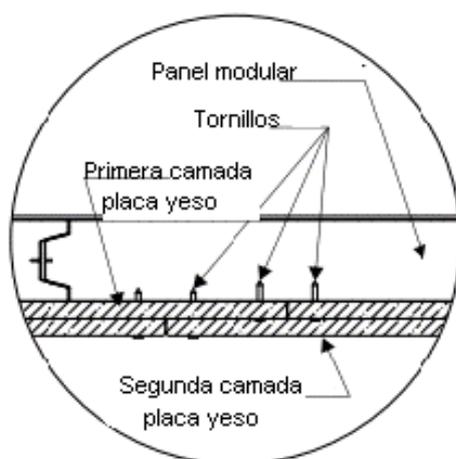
Detalle de la fijación del revestimiento doble de Drywall
